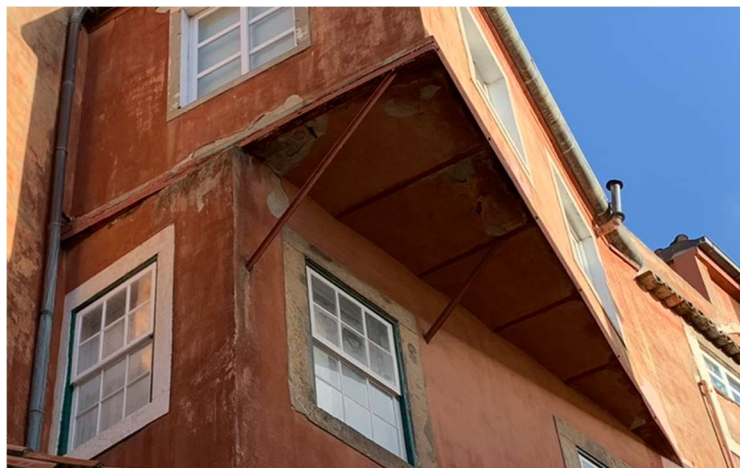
Estruturas metálicas no topo da fachada (escoras e vigas de piso)
